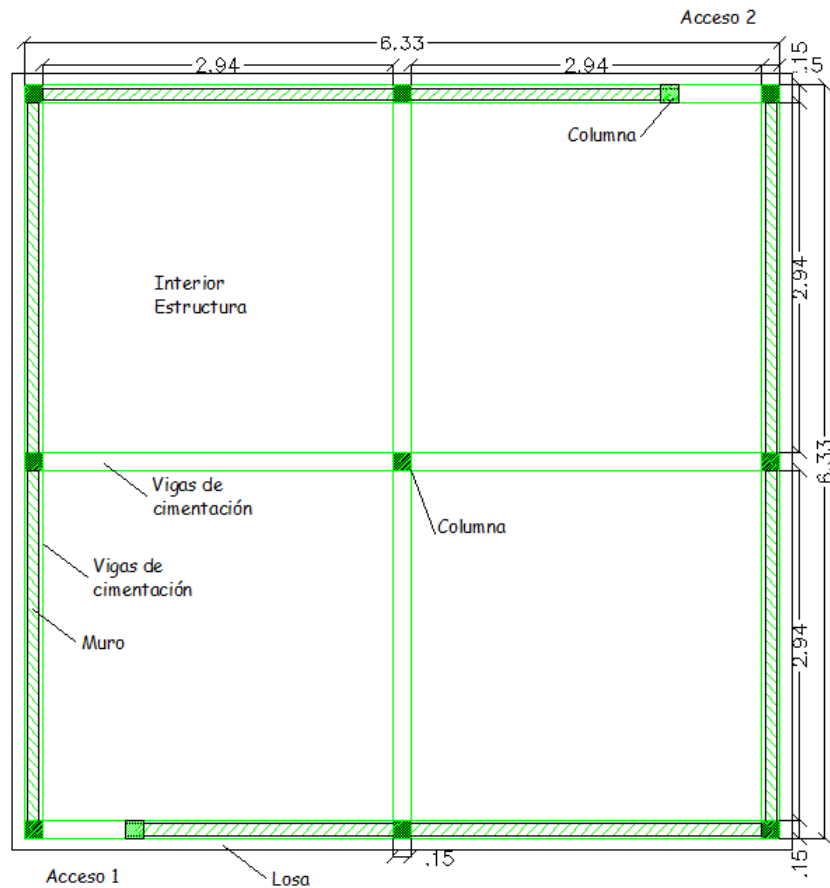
Configuración estructural de la estructura tipo vivienda construida por elementos prPEAD. Fuente: Autor.
